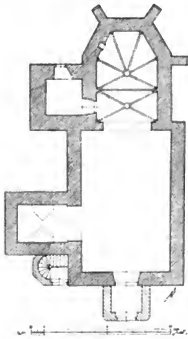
Wischnowa. Grundriss der Kirche.
